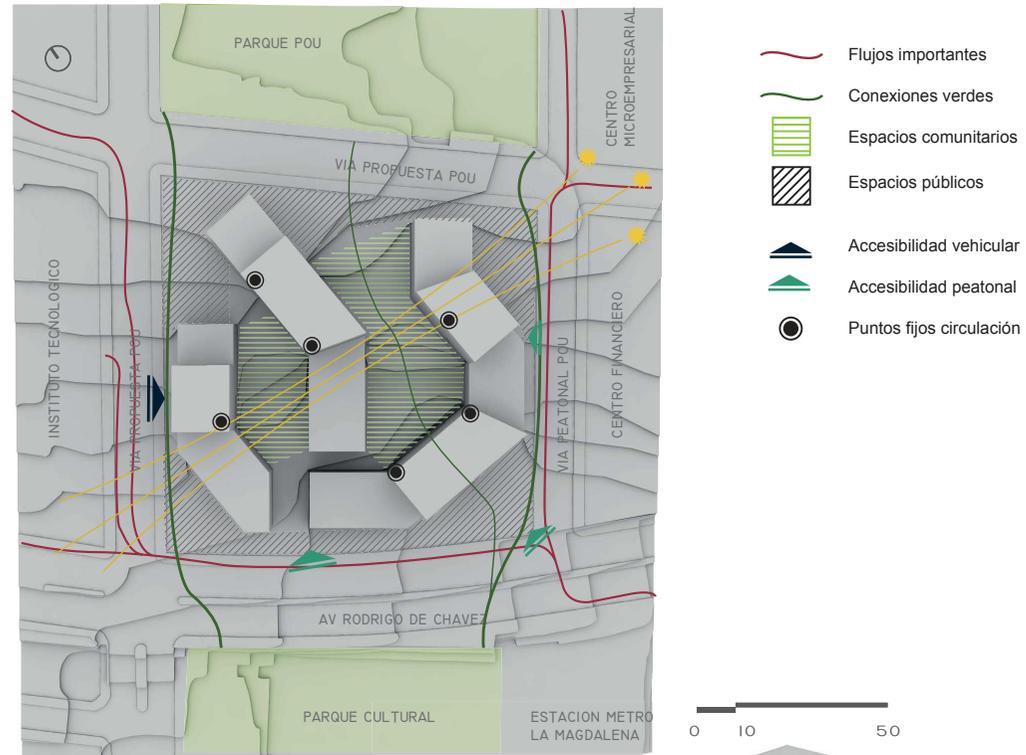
Propuesta 2 plan masa - implantación y estrategias
